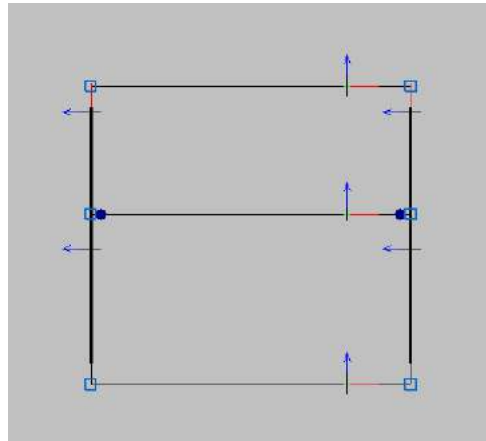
Vista en planta nivel destinado a albergar equipos del elevador.
